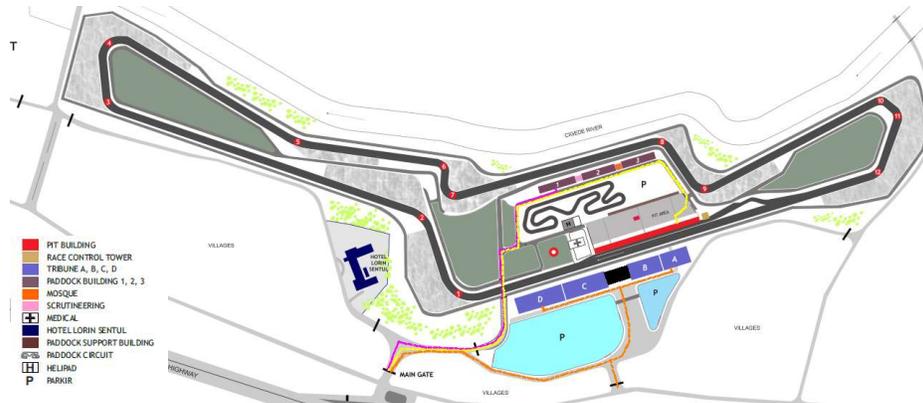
Konsep Bentuk massa bangunan Pit
